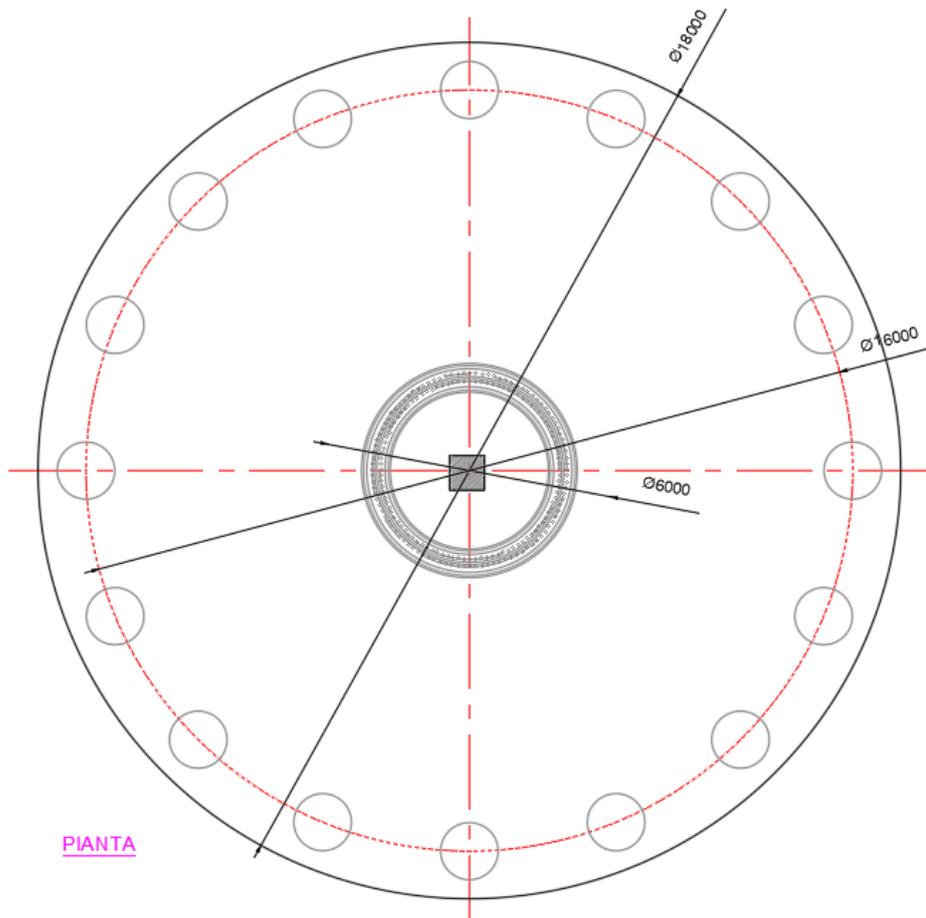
Planimetria dell'opere di fondazione in conglomerato cementizio armato.
